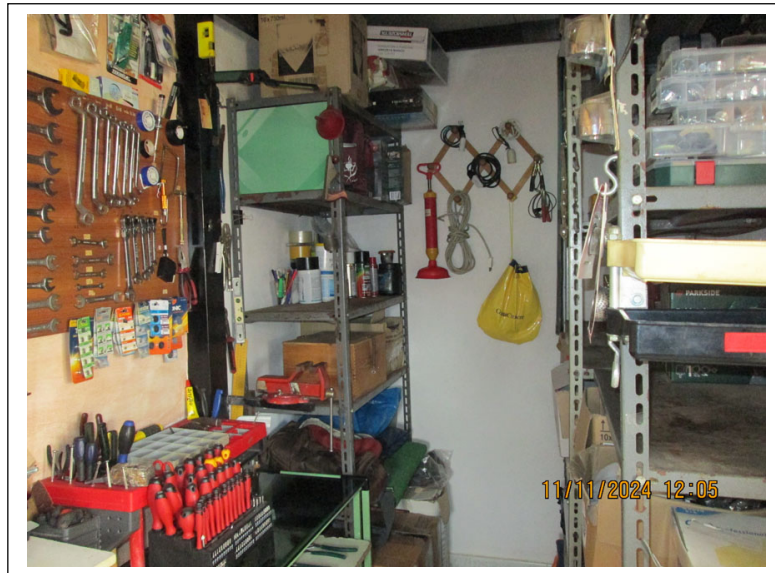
Soffitta- locale di deposito dove arriva la scala a chiocciola interna
